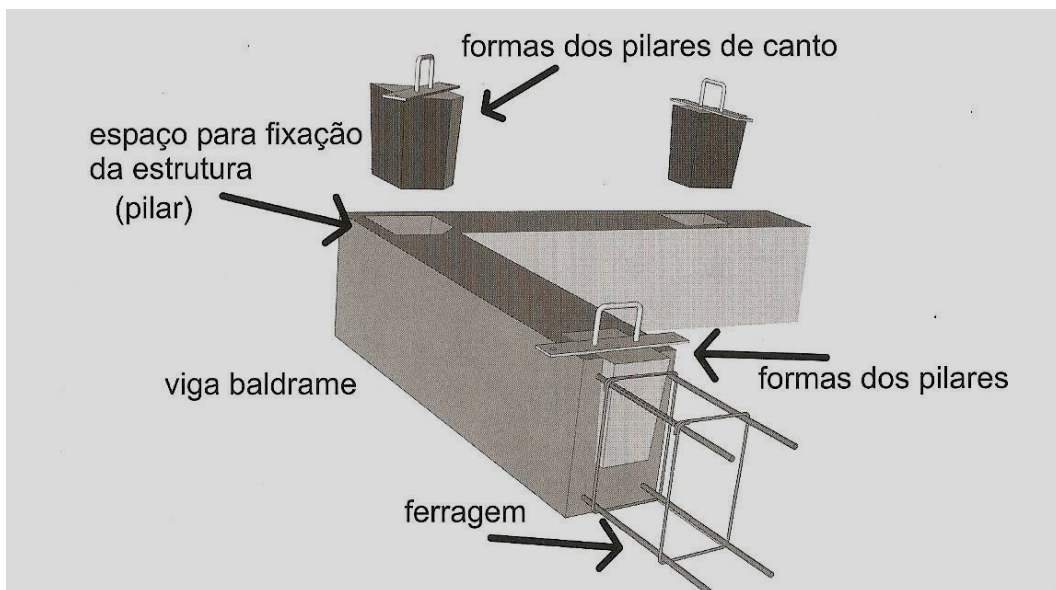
Viga de baldrame com encaixes dos pilares.
